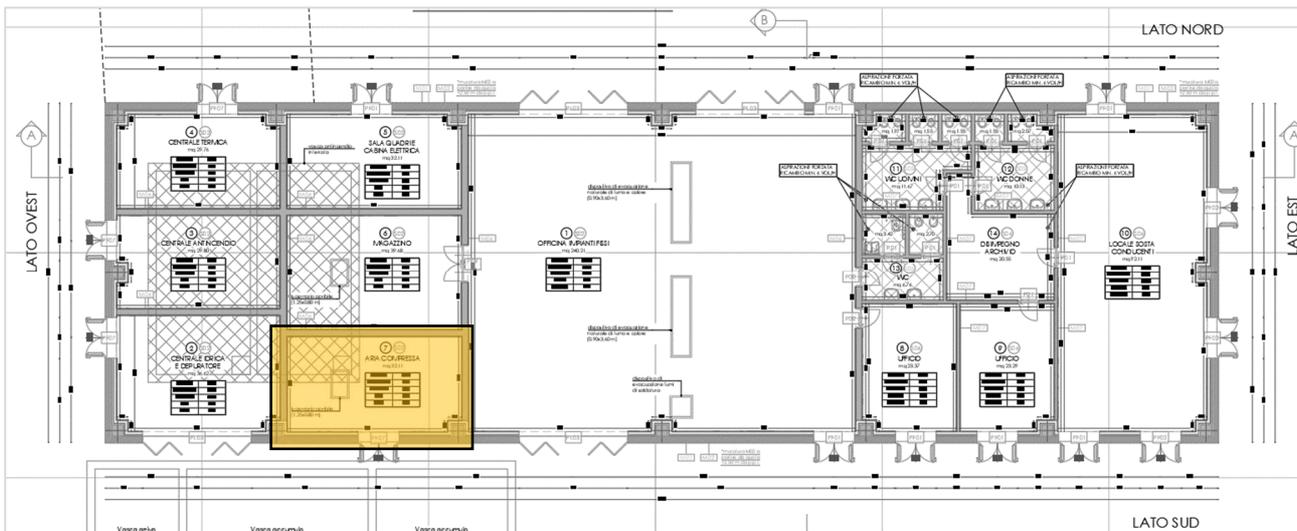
Vista planimetrica officina rotabili - impianto aria compressa in evidenza
